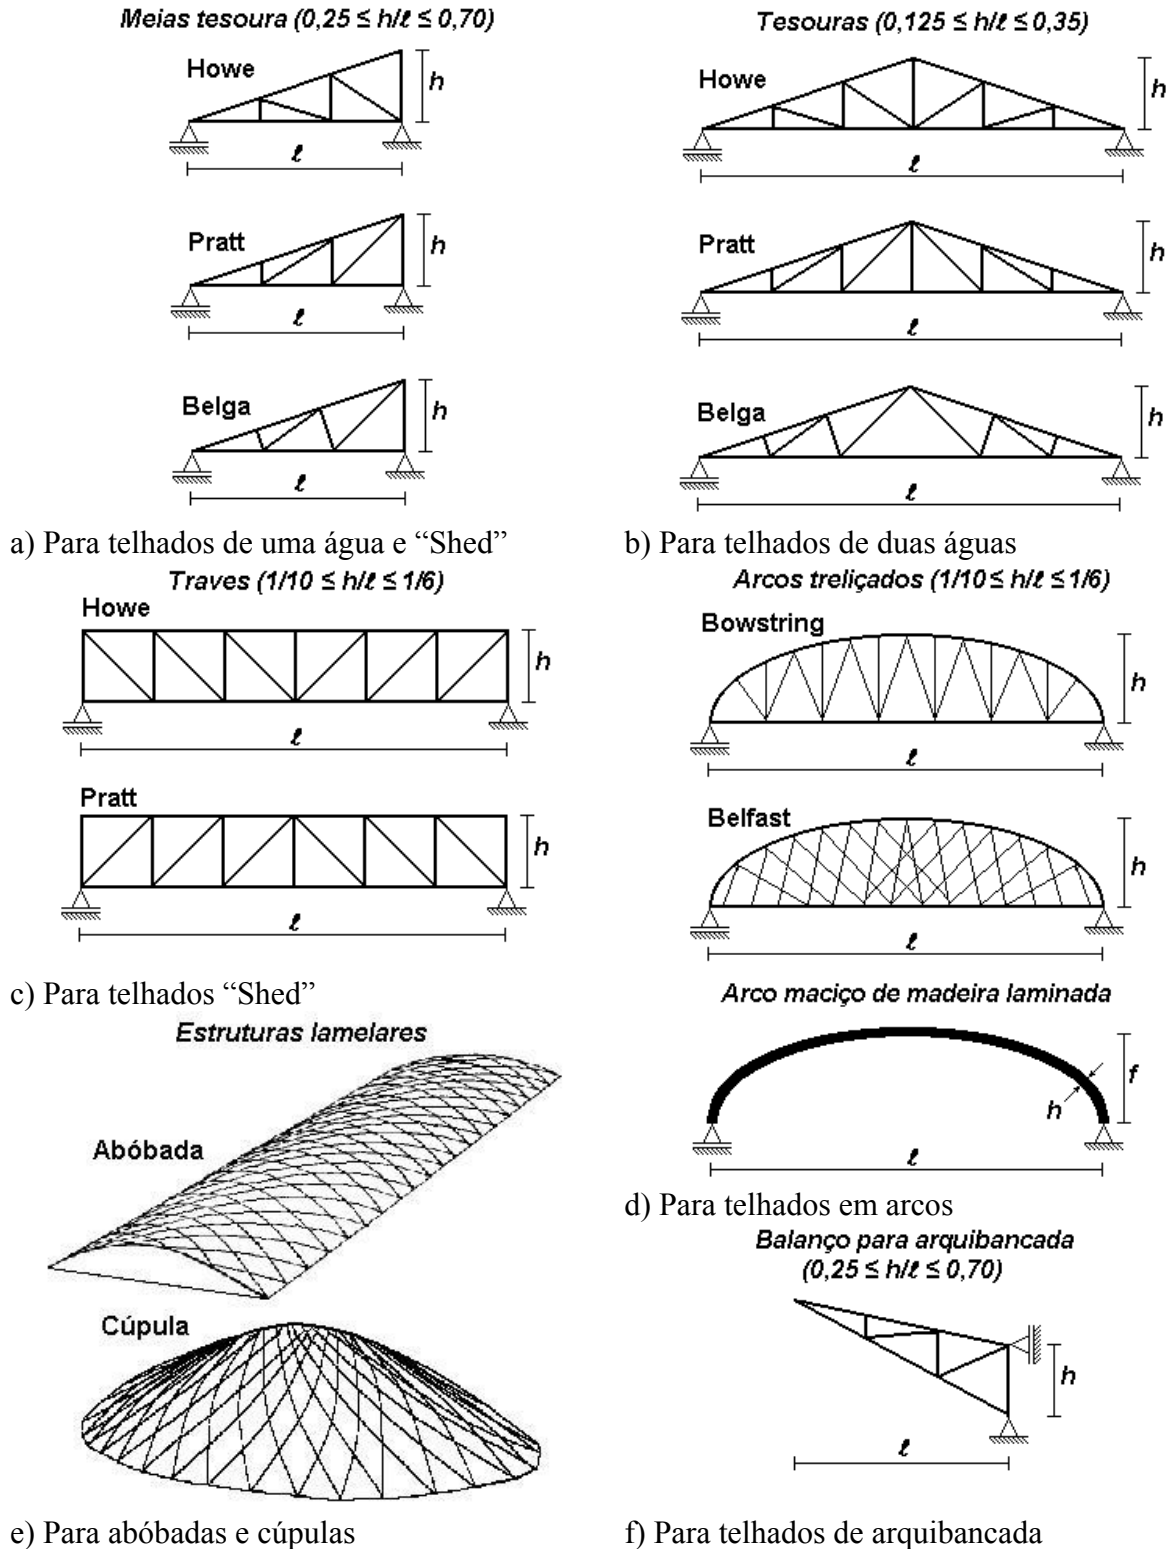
Tipos de estruturas principais utilizadas em telhados
